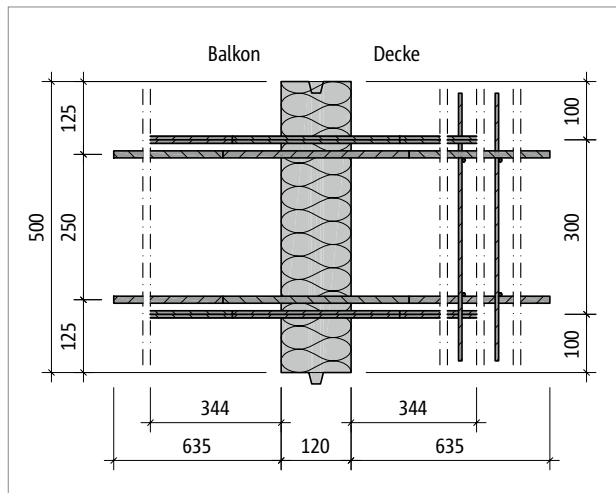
Schöck Isokorb® XT Typ DP-MM1-VV1: Grundriss
